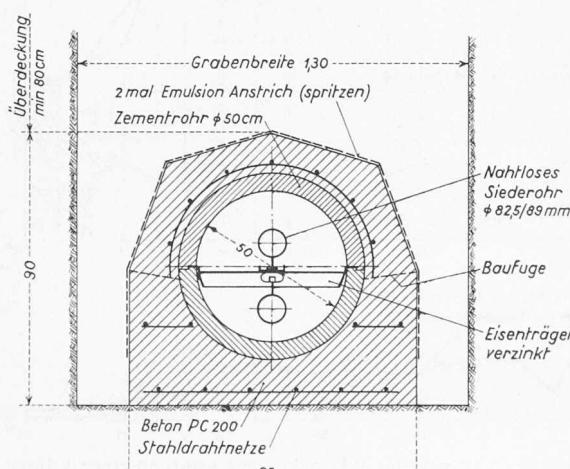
Kanalprofil für kleine Leitungen, 1:25
